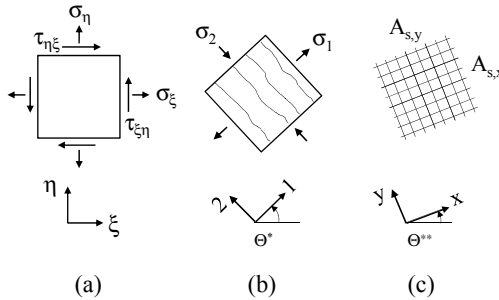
Definition der Koordinatensysteme: (a) allgemeiner Beanspruchungszustand, (b) Hauptspannungen mit Rissbildung und (c) Bewehrungsrichtungen
